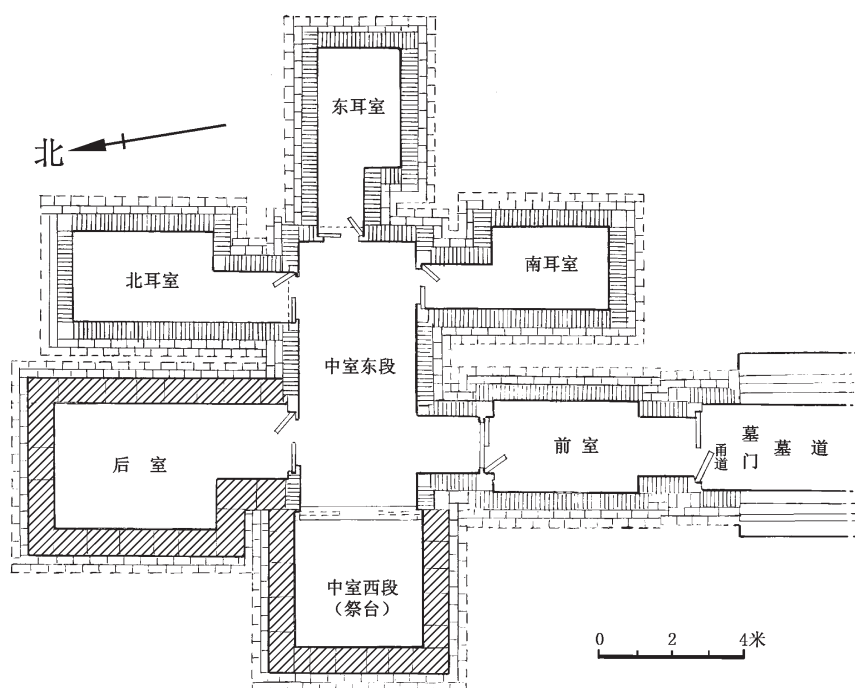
河南省密县打虎亭 2 号汉墓平面图 (1/200)
